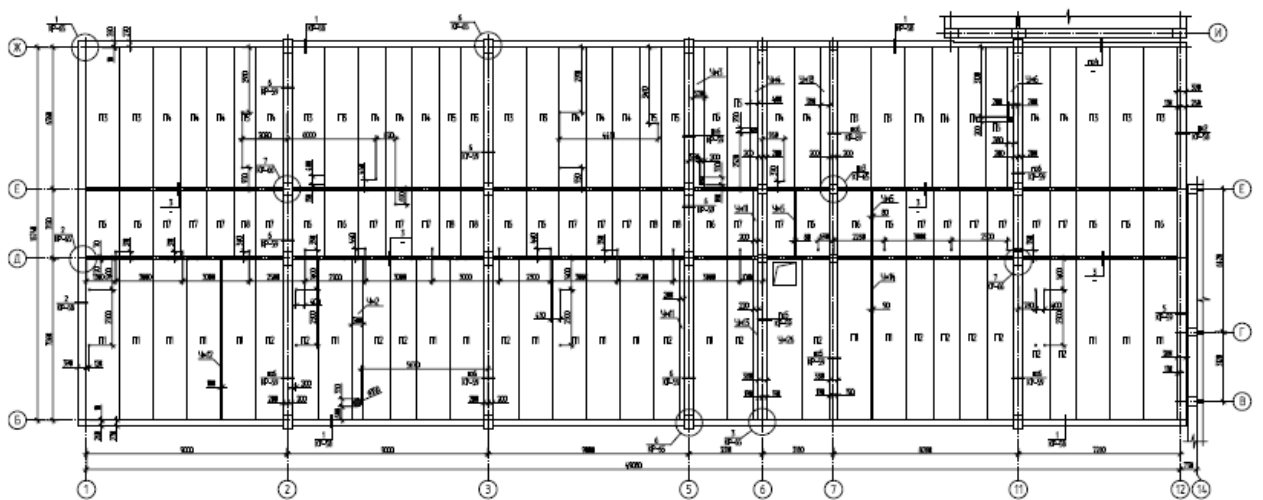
Схема расположения плит перекрытия и антисейсмического пояса на отм. + 6,300 в осях Б-Ж, 1-12
